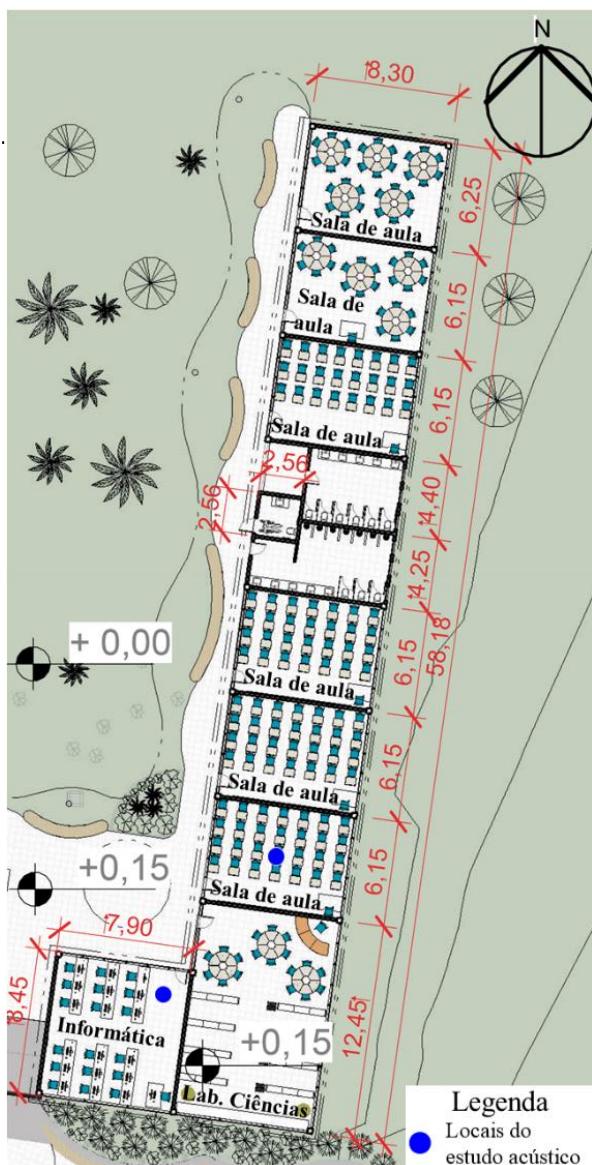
Planta baixa da Escola Trinta de Outubro e indicação dos locais do estudo acústico.
